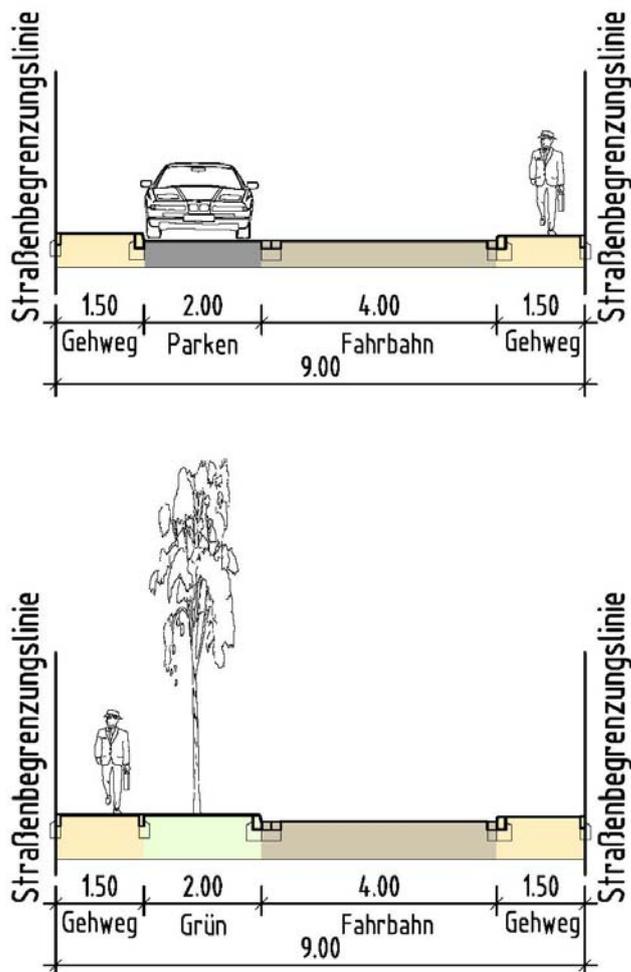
Straßenquerschnitt Ringerschließung / Planstraßen B, C und D
